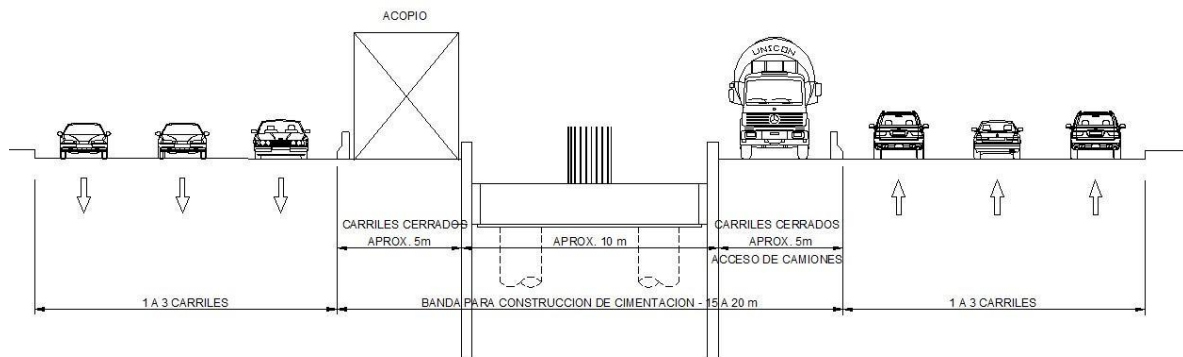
Zona de trabajo necesaria para ejecución de cimentaciones
